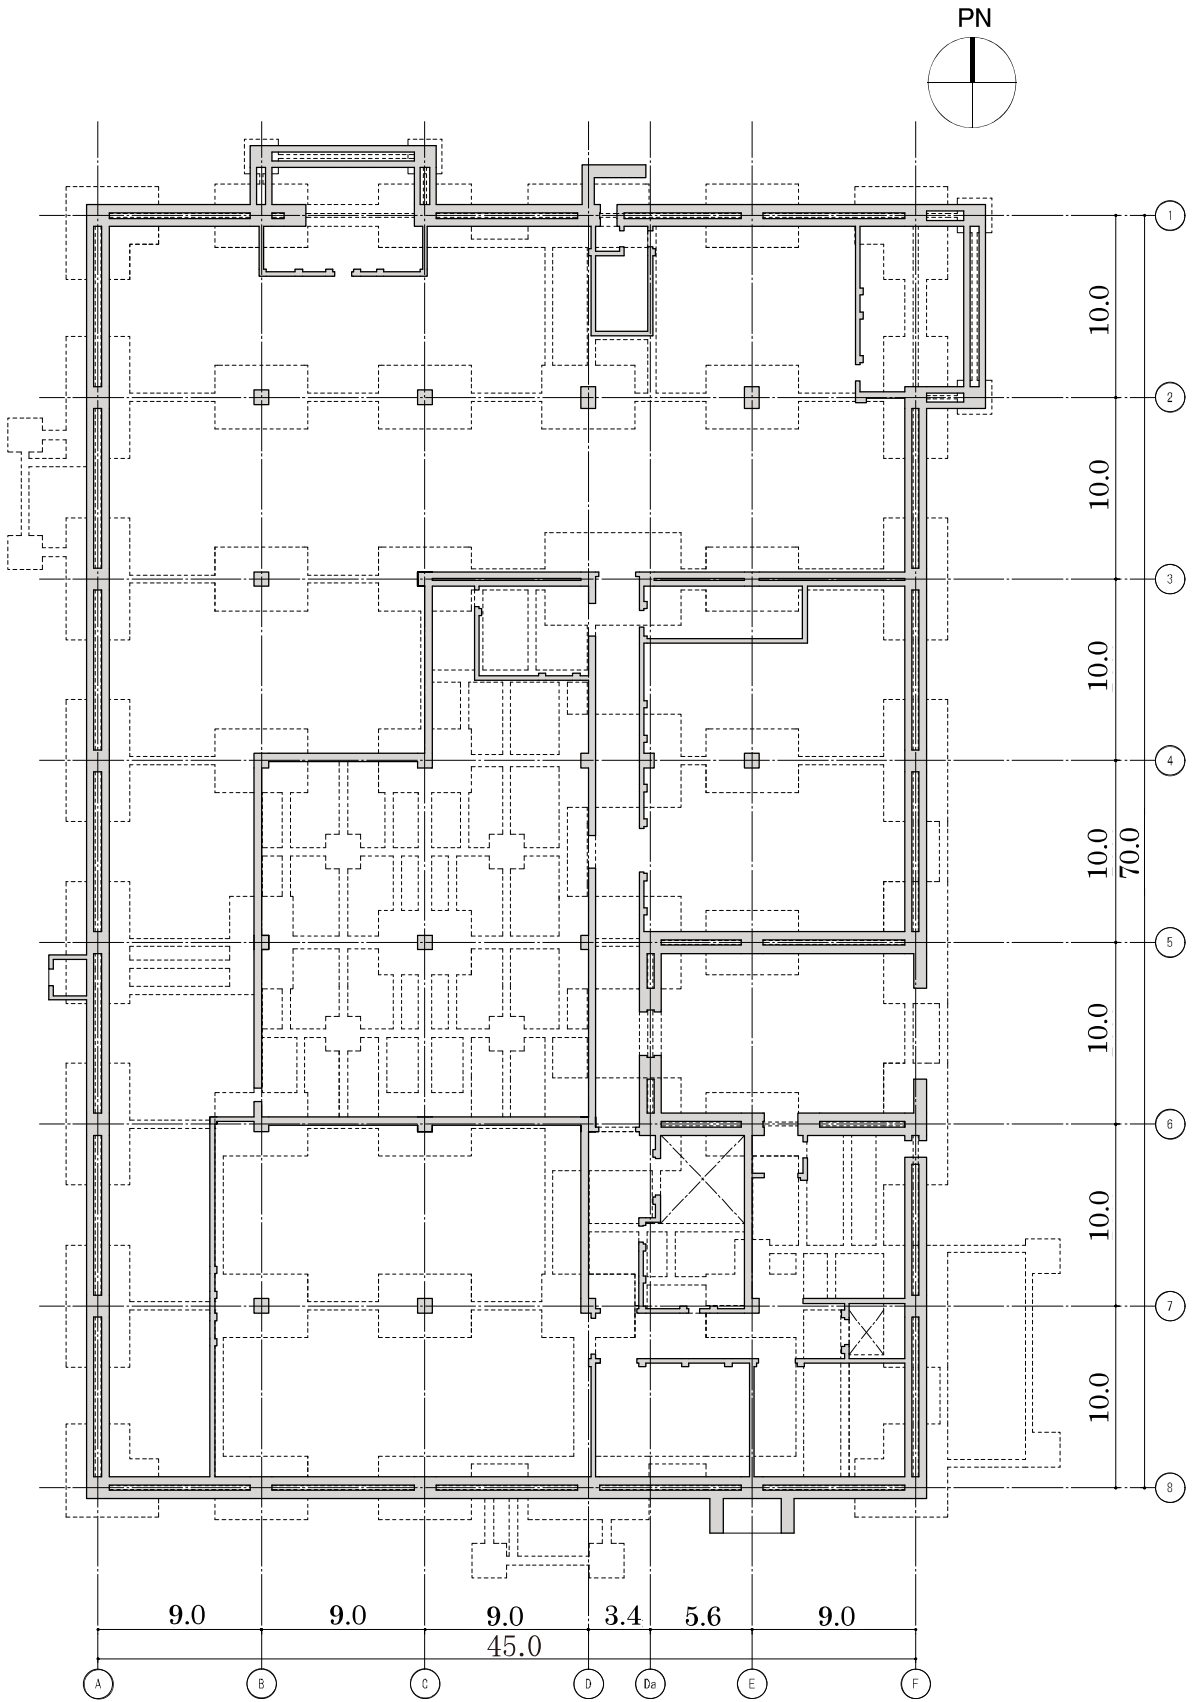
1階平面図 (G.L. +0.30) (单位 : m)
